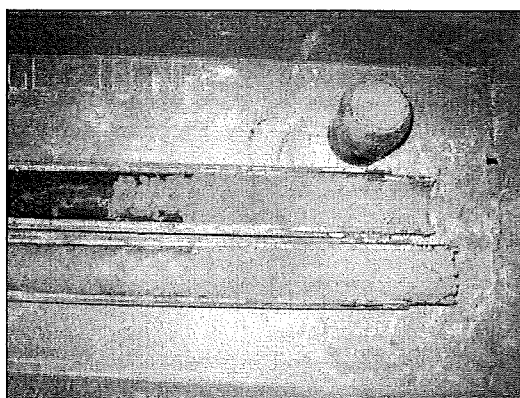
Sondeig S-1. SPT a 8,0 metres.
